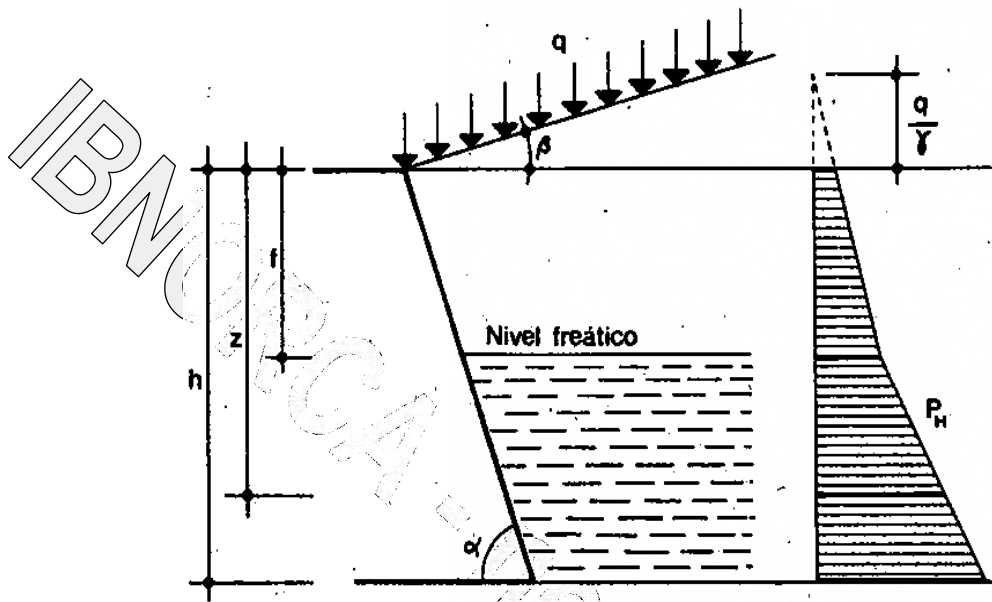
Croquis de un muro en terreno anegado.
